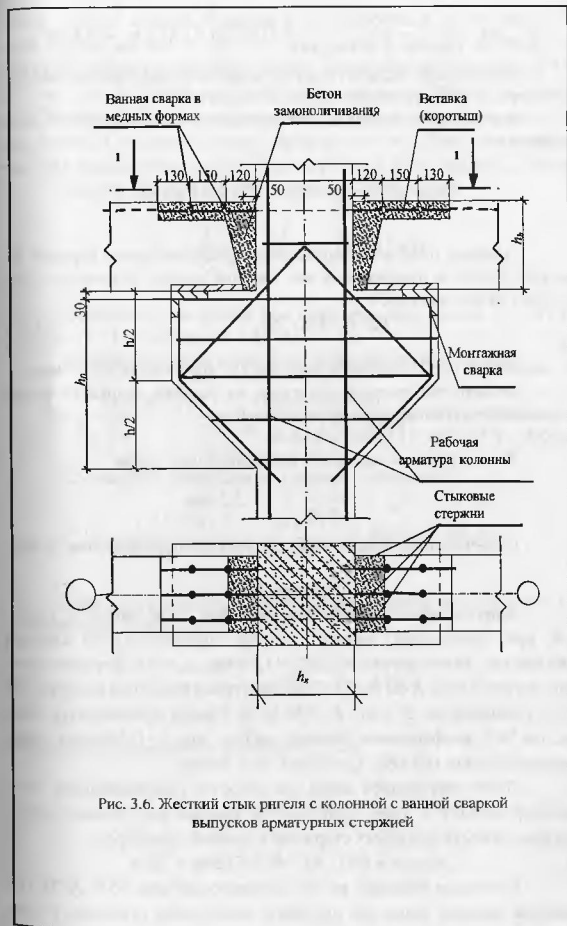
Жесткий стык ригеля с колонной с ванной сваркой выпусков арматурных стержней
